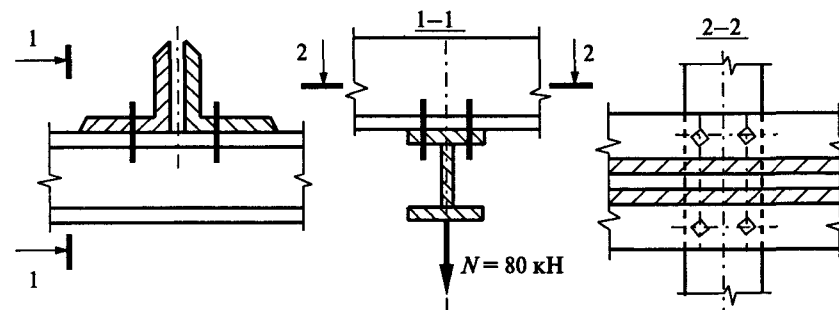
Крепление балки болтами — к примеру 8.4
